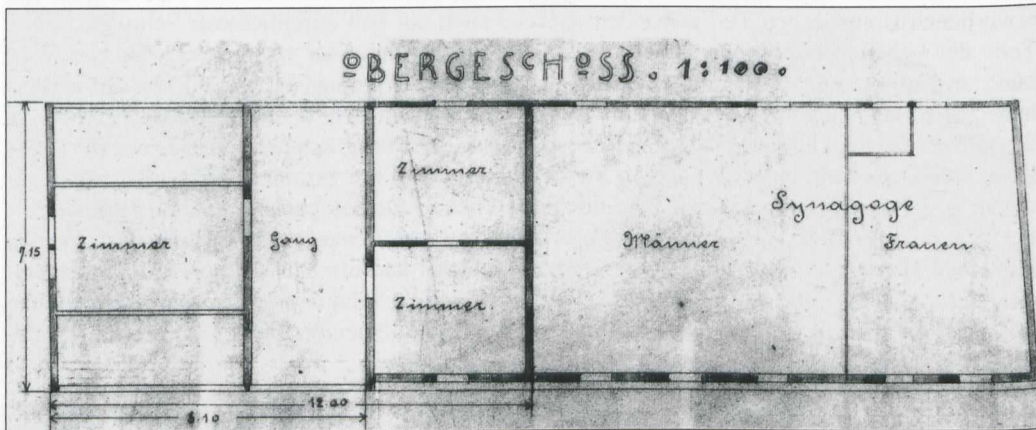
Grundriss des Obergeschosses. Planzeichnung des Bezirksbaumeisters Häußler, 1908 (Pfälzisches Landesarchiv, Speyer)
